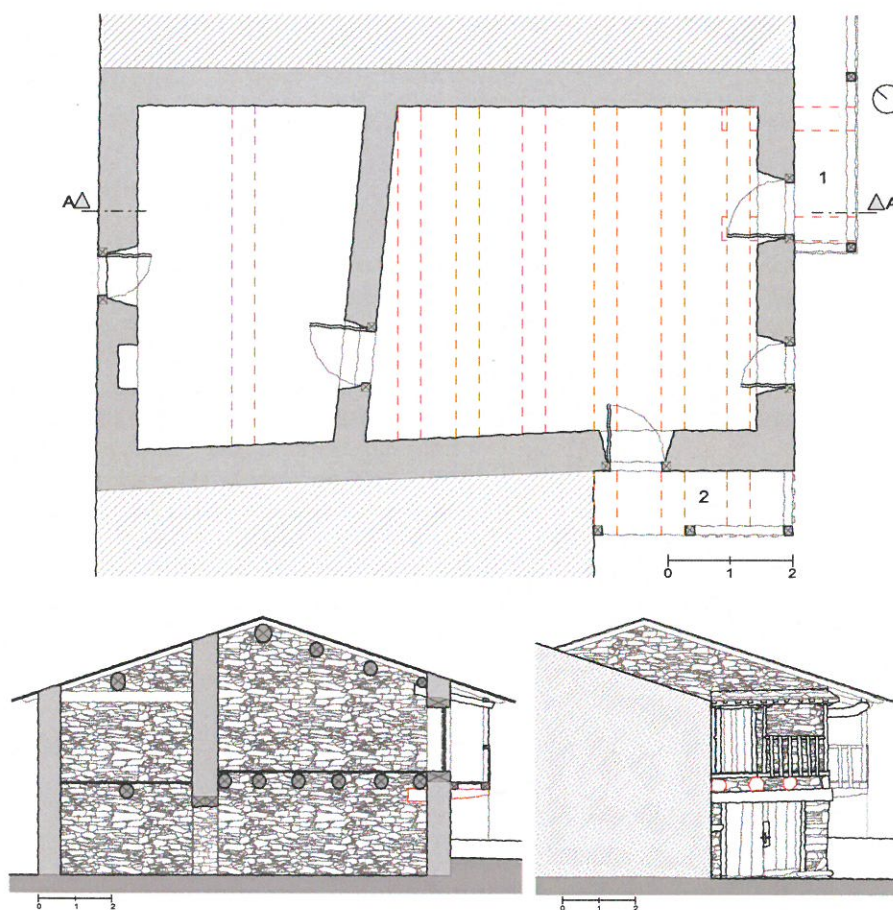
Planta, corte e alçado com indicação de estrutura (Inq.06).
